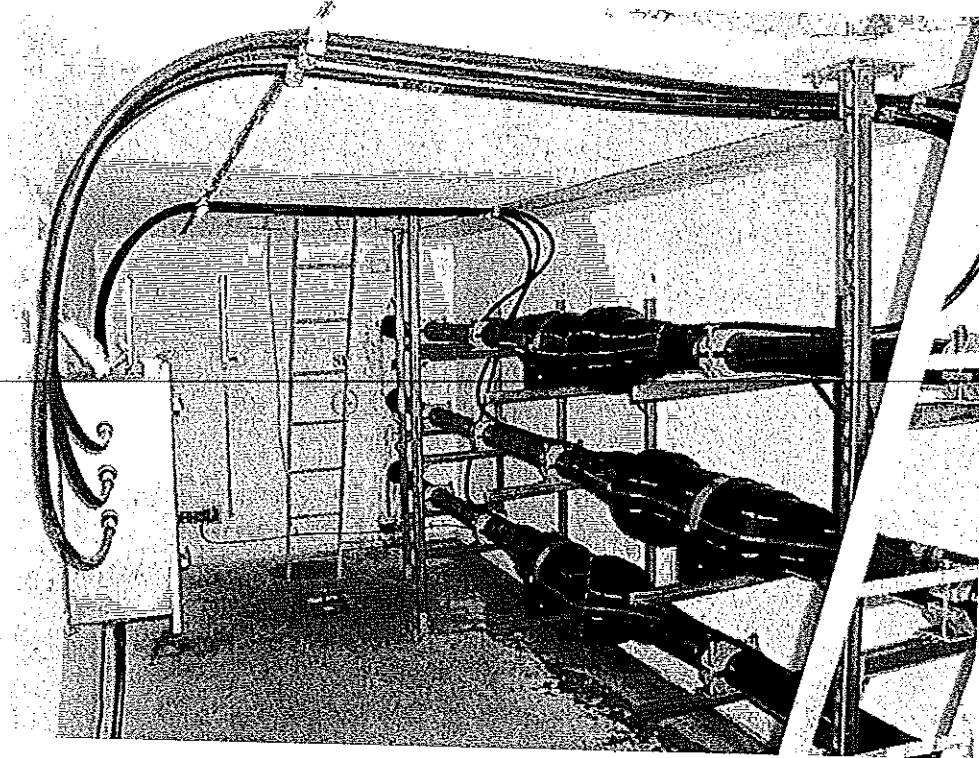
Крепление в кабельном помещении на металлоконструкции кабелей и соединительных муфт с выводами экранов для соединения методом транспозиции
